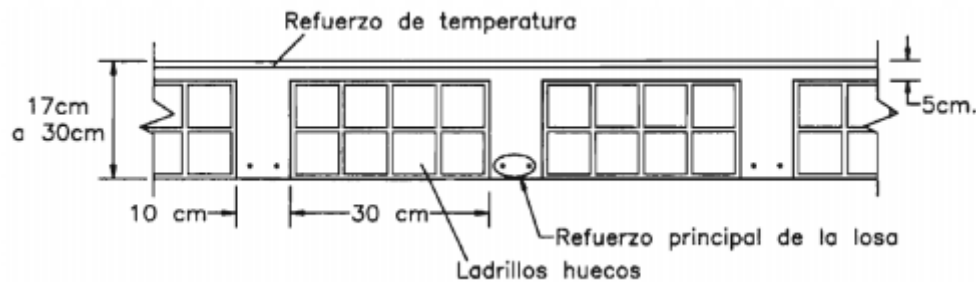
Geometría de una losa aligerada (Harsem, 2002)
